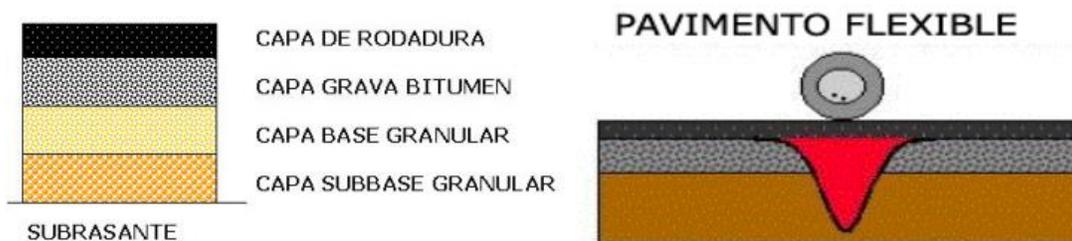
Esquema de un pavimento flexible (Ing. Claudio Giordani, Ing. Diego Leone, pavimento)
